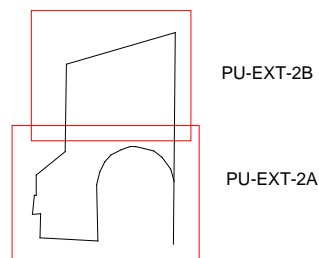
Posición de los pares de la puerta Sur-Oeste de la Muralla
